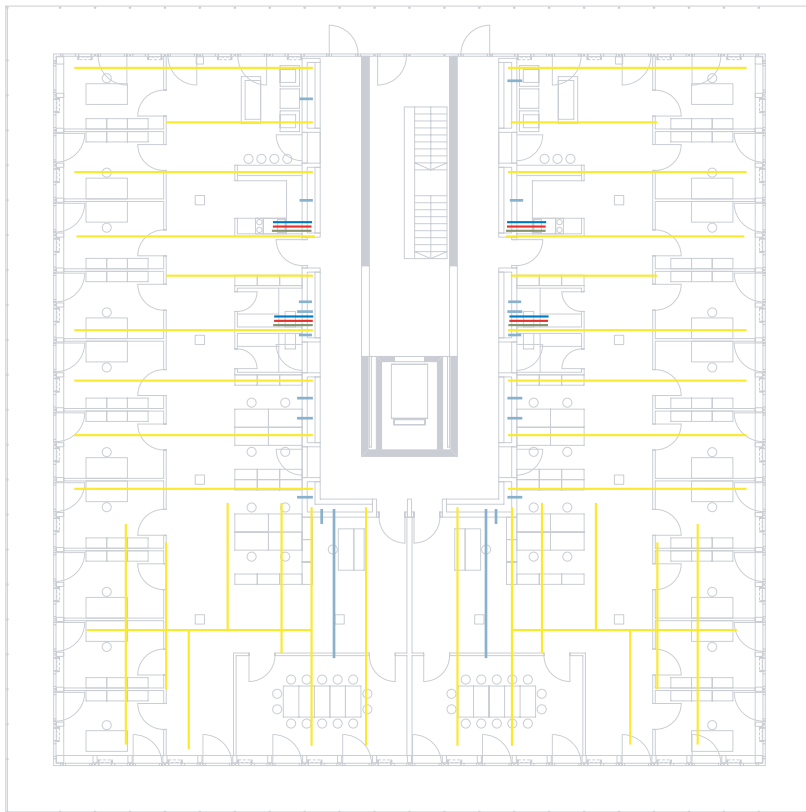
Varianten zur Leitungsführung bei unterschiedlicher Grundrissgestaltung
